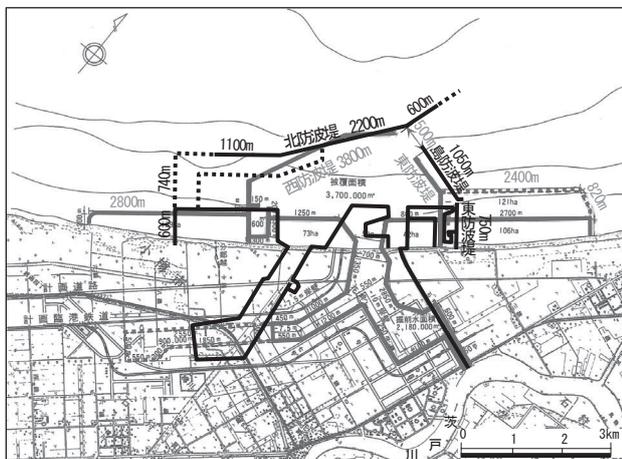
(c) 北海道交通研究会による計画図と現在の港湾計画図を重ね合わせた平面図
